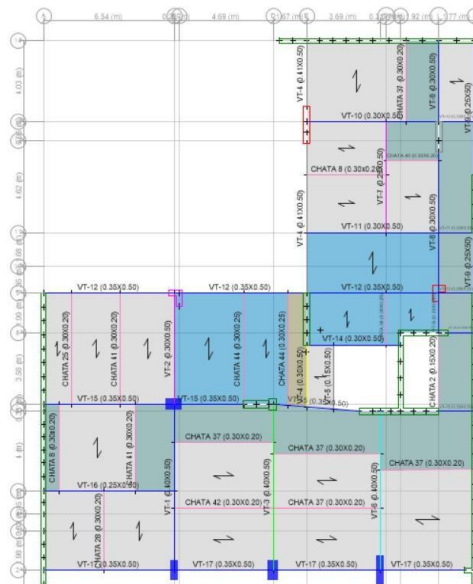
Vista de una planta típica del edificio Residencial Casanova
